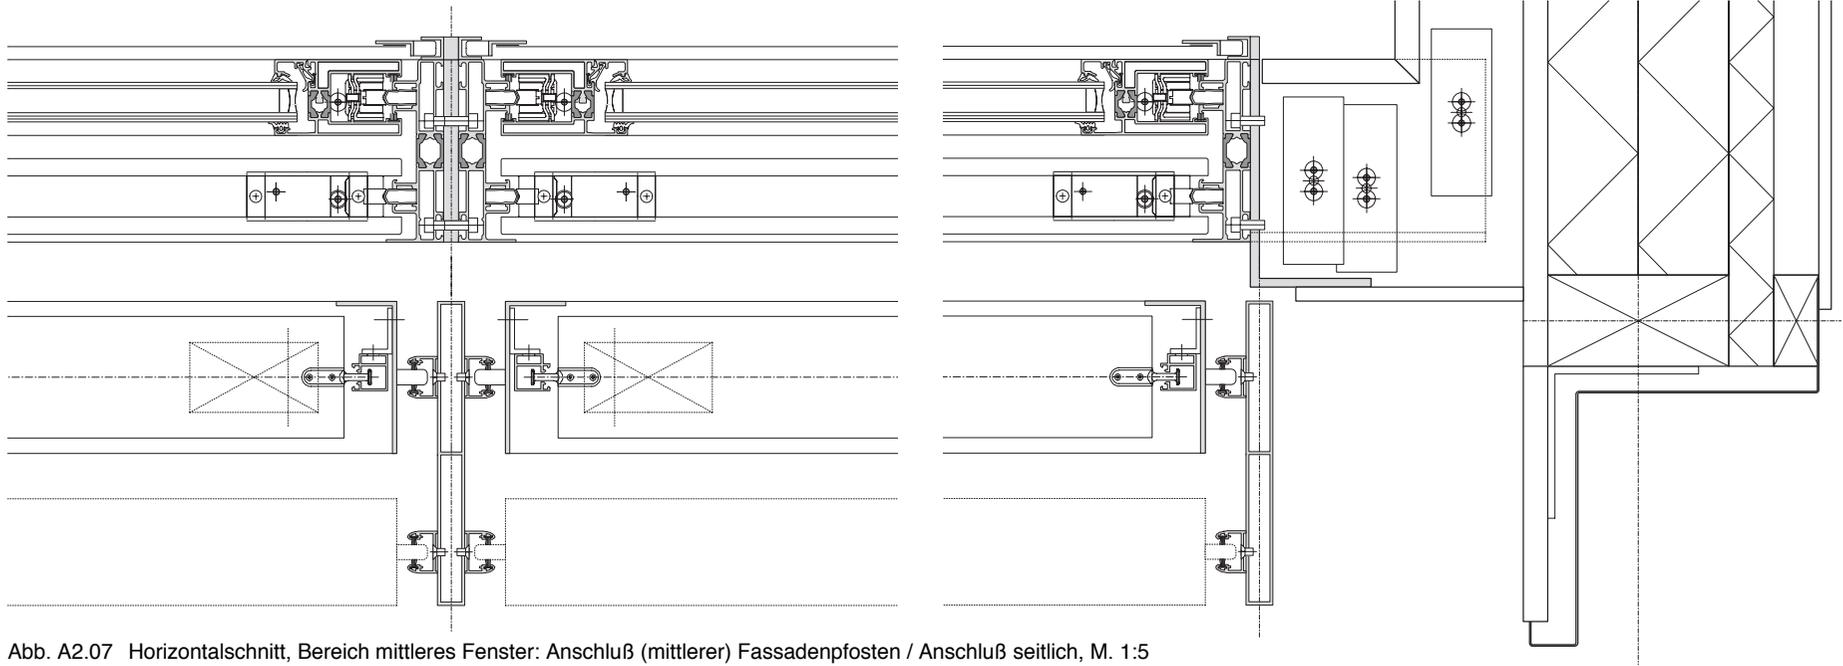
Horizontalschnitt, Bereich mittleres Fenster: Anschluß (mittlerer) Fassadenpfosten / Anschluß seitlich, M. 1:5
